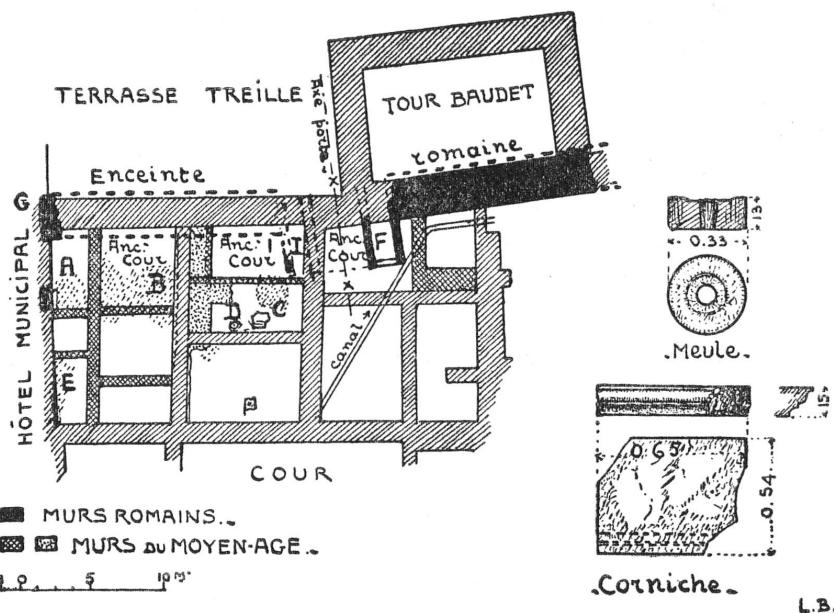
Plan des fouilles sous l'Hôtel-de-Ville.
